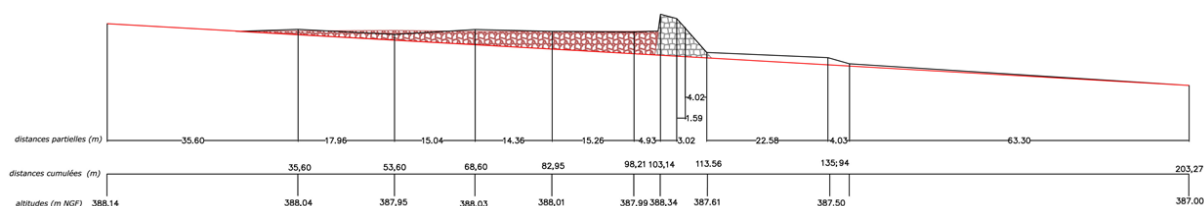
profil en long de la rivière au niveau du seuil de Lavaur
